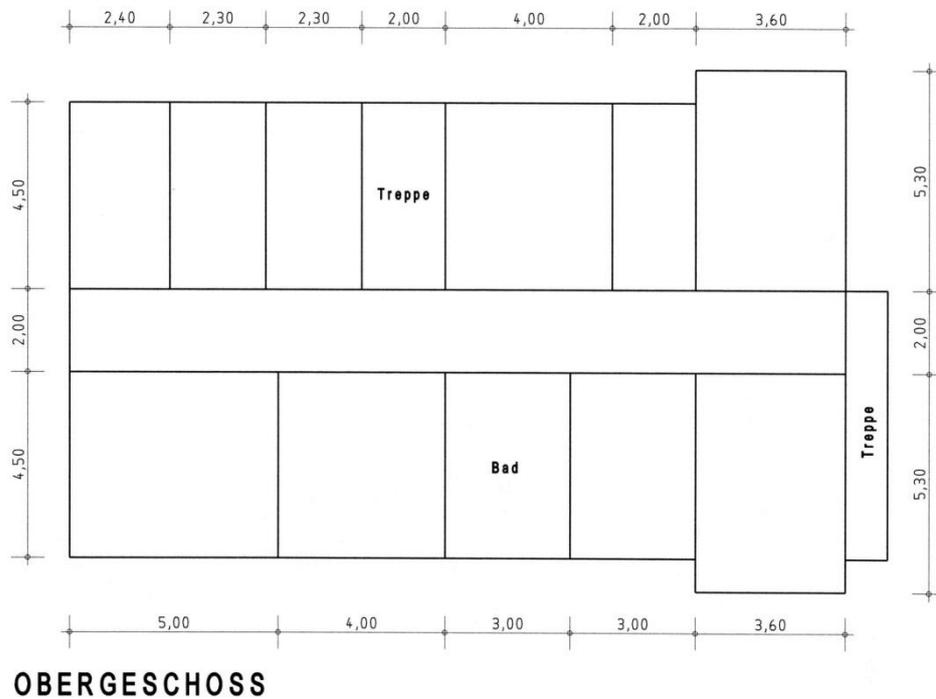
Plano de la primera planta. Fuente: VETH, Margarete.
